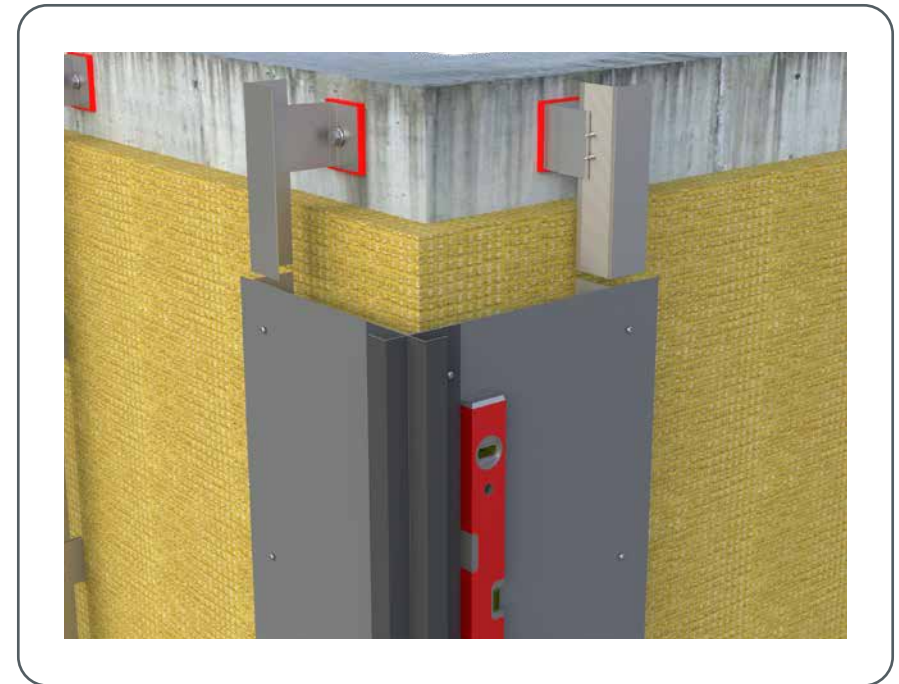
• Vanjski kut horizontalne fasadne kazete Siding
